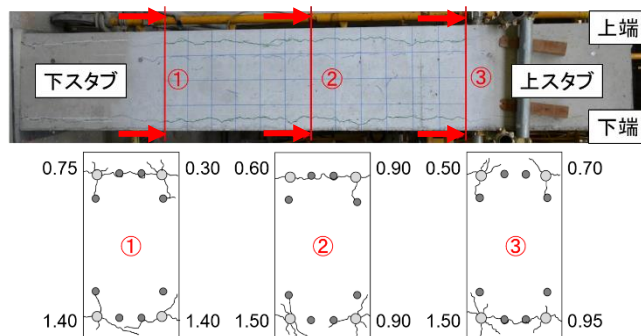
Monitor 試験体のひび割れ状況（単位：mm）
